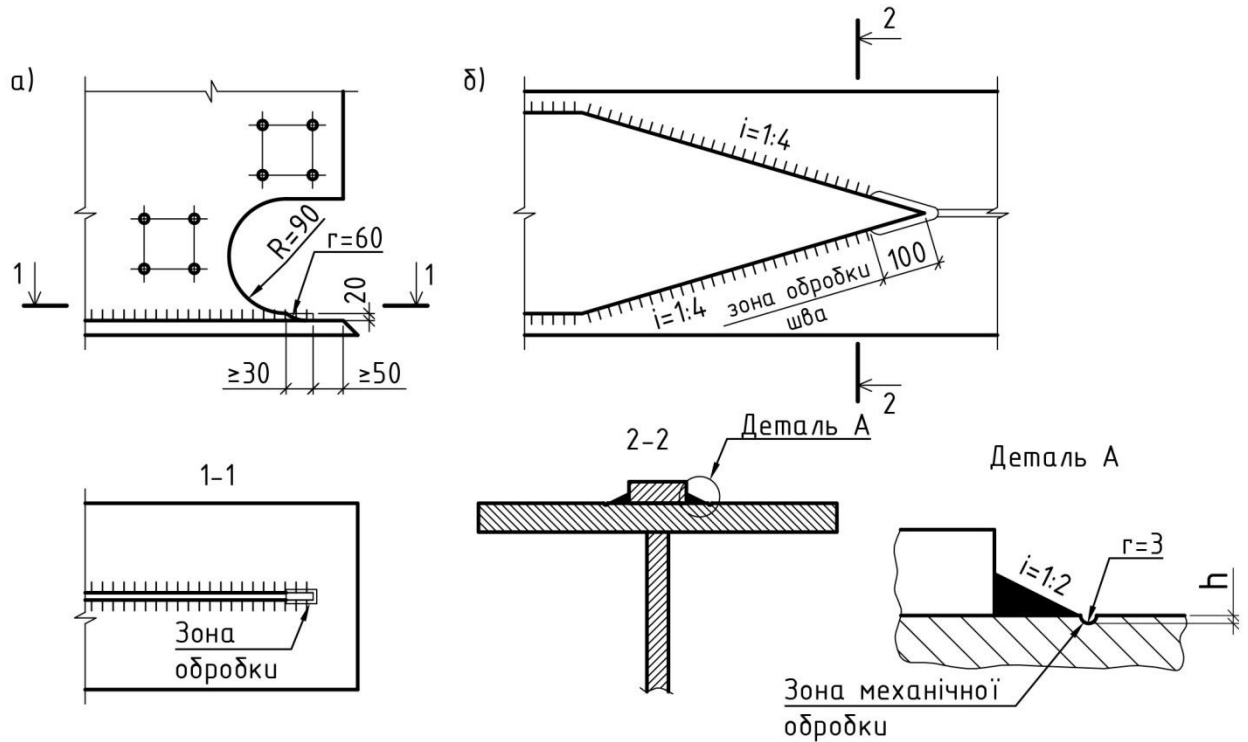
Оброблення кутових швів елементів, що обриваються:
